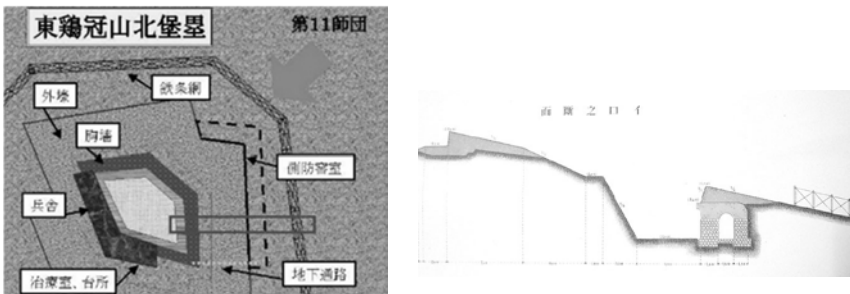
東鷄冠山北堡壘平面図（左）および断面図（平面図で四角に囲った部分）
